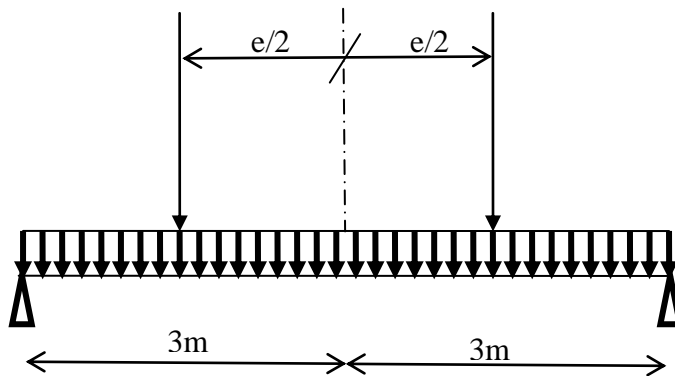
Disposition des efforts sur la poutre de roulement
